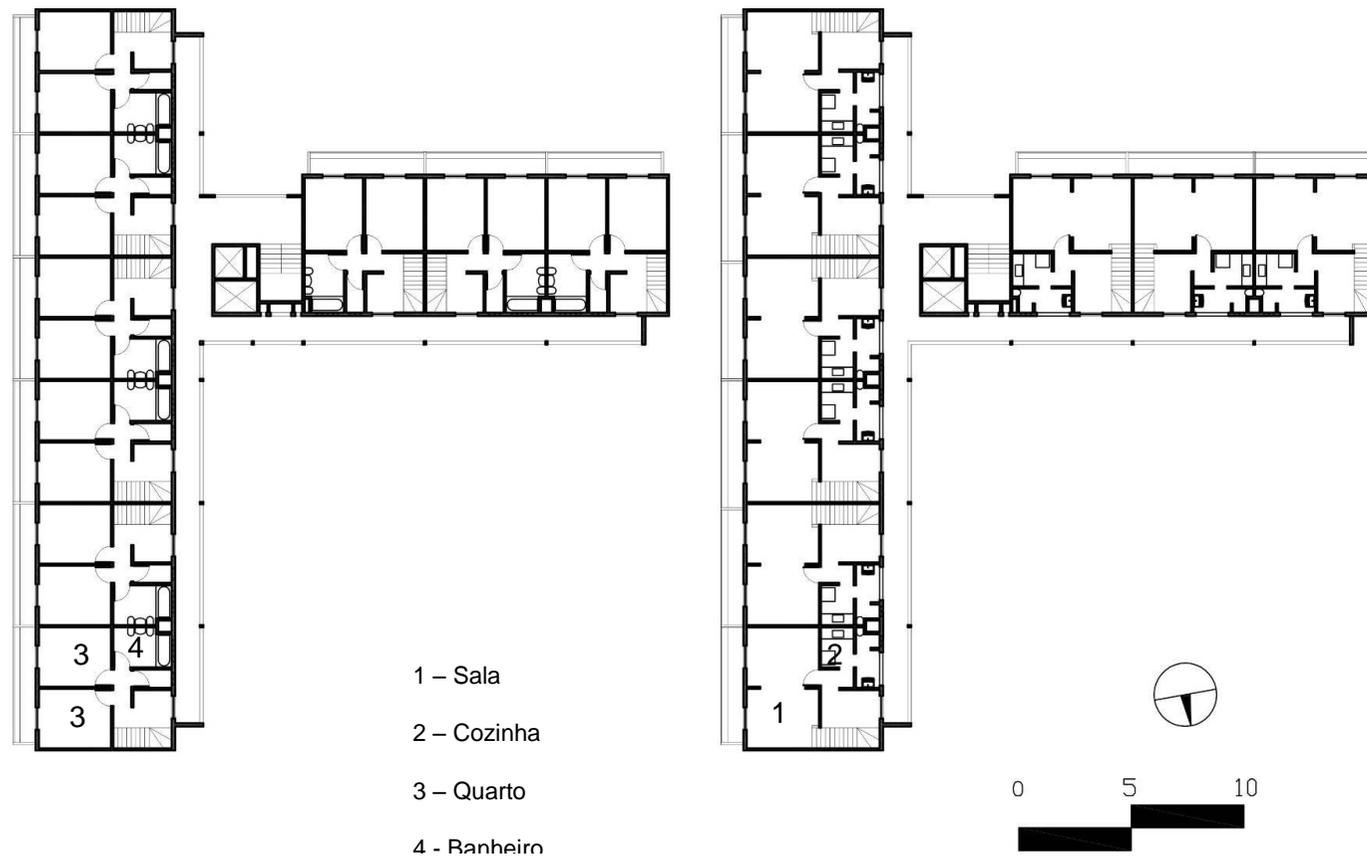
Plantas dos pavimentos residenciais do IAPI de Recife. Desenho da autora.
